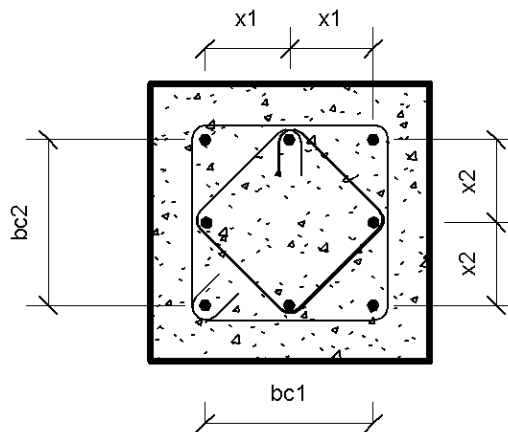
Representación del refuerzo transversal de las columnas OMF
